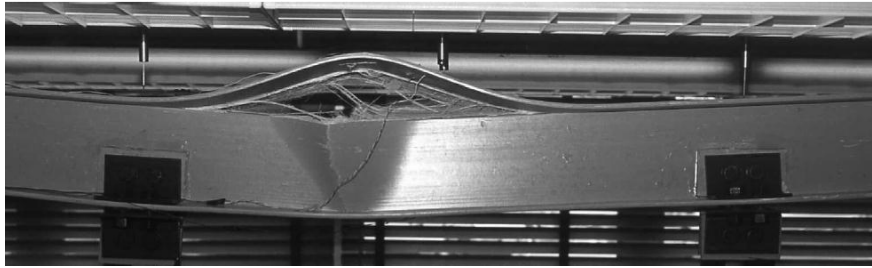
Rotura na ligação banzo-alma por instabilidade local do banzo superior de uma viga [3.3]
